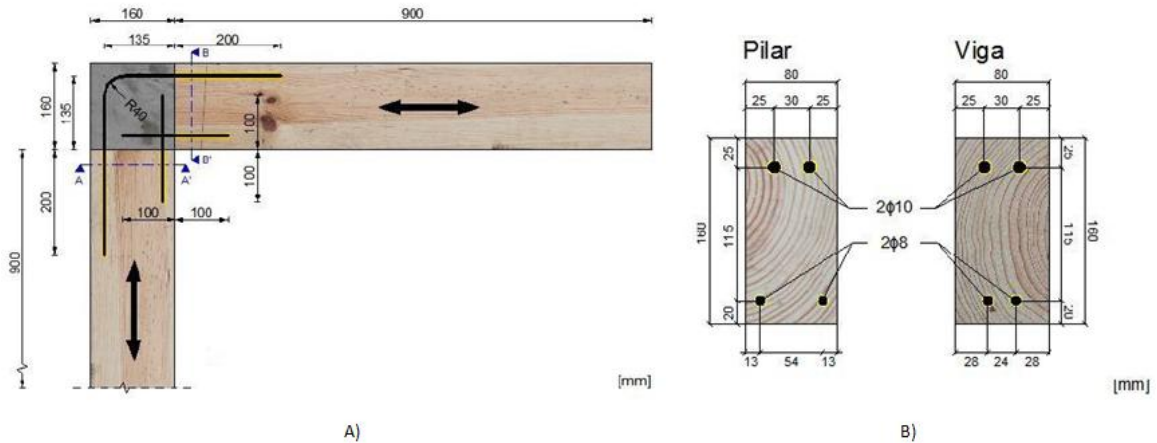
Amostra de ensaio: A) Disposição e dimensões dos componentes da ligação; B) Corte AA' e BB' da secção da madeira. (Gonçalves, 2014)
